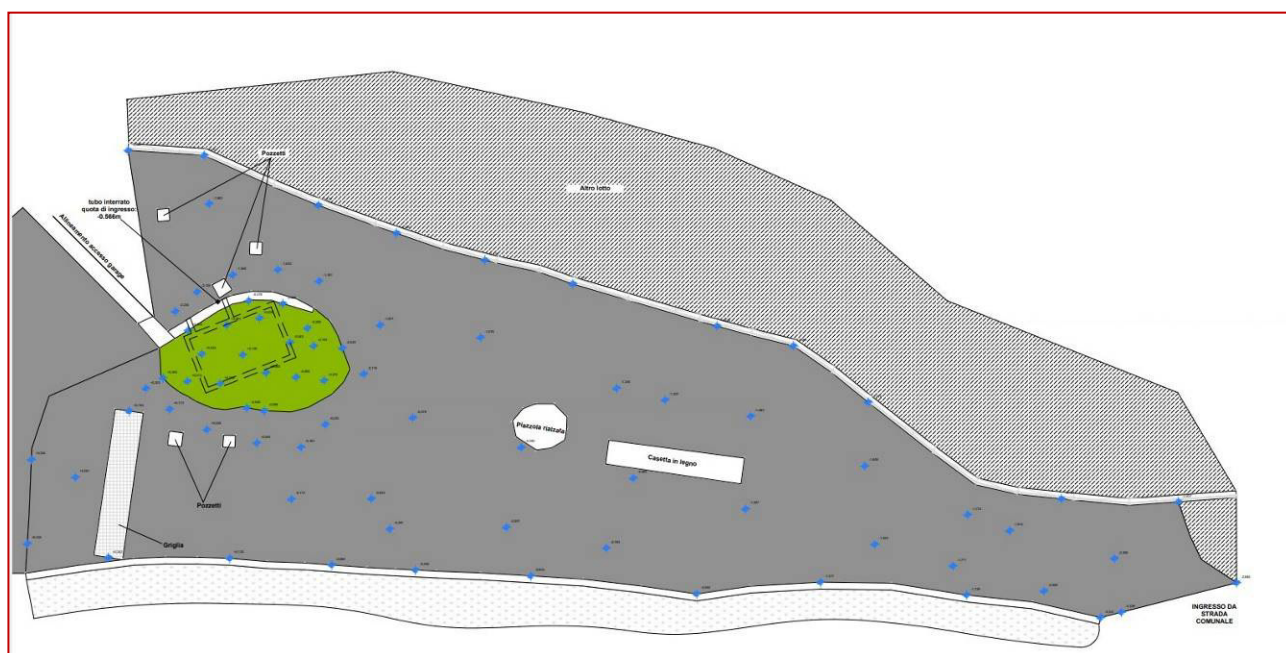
Estratto TAV. 02 di progetto - Planimetria
